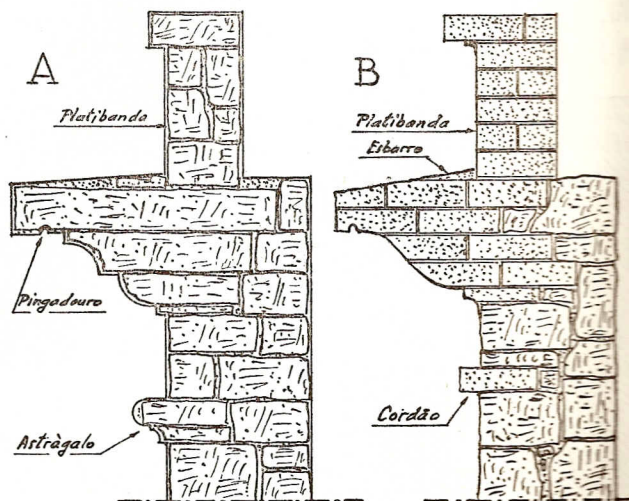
CIMALKHAS E PLATIBANDAS VULGARES A) Construção de Alvenaria de pedra; B) Construção de tijolo
